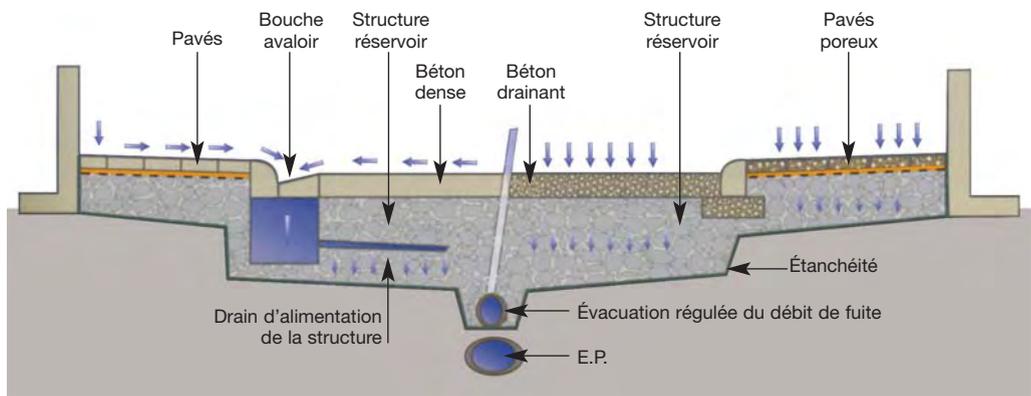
Schéma de principe d'une chaussée réservoir en béton
